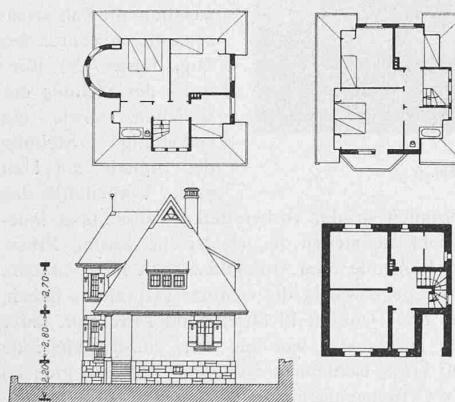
und 2. Lageplan, Erdgeschoss und Dachstockgrundrisse der Häuser I bis IV.
